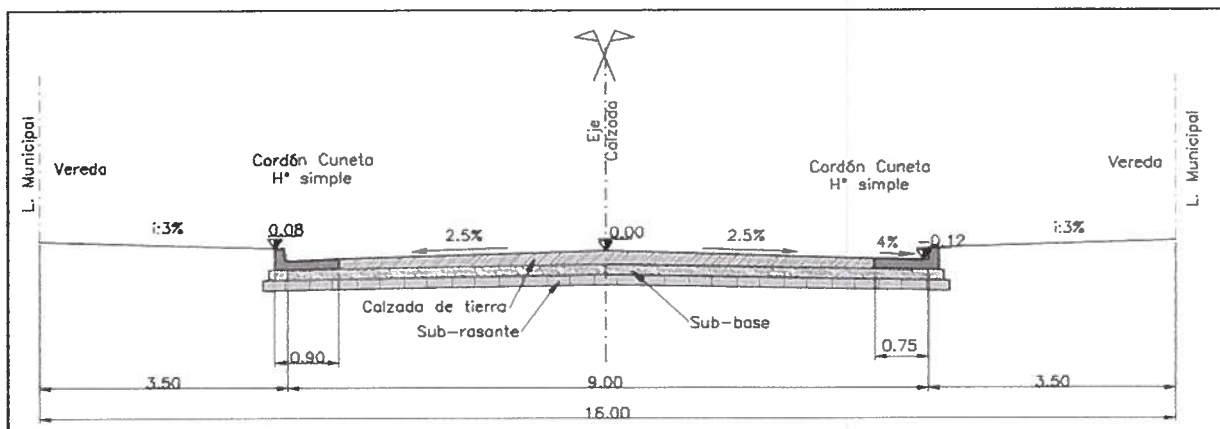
Perfil transversal tipo 2. Calzada Tierra
